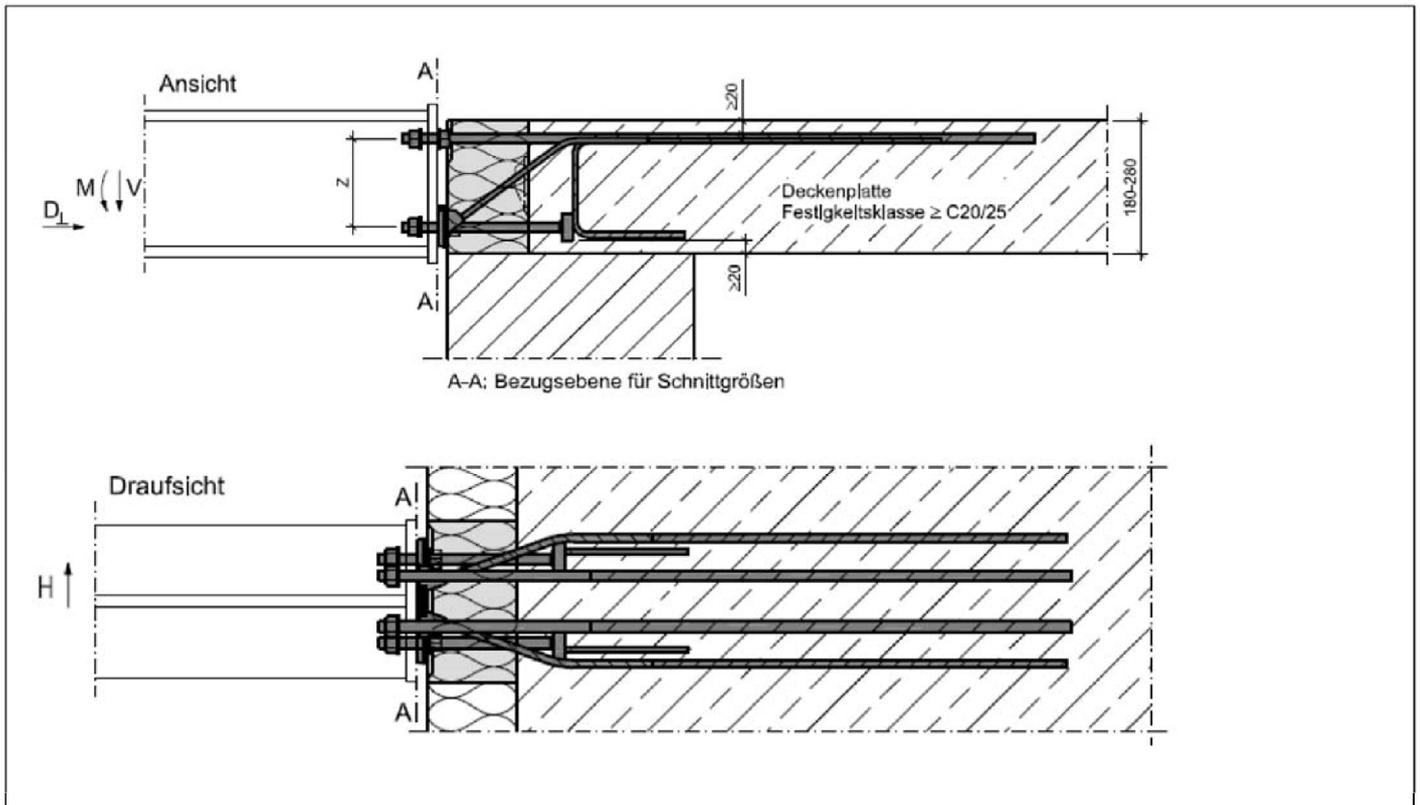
und 68: Schöck Isokorb® XT Typ SK-M1-V2, Schnittgrößendefinition
